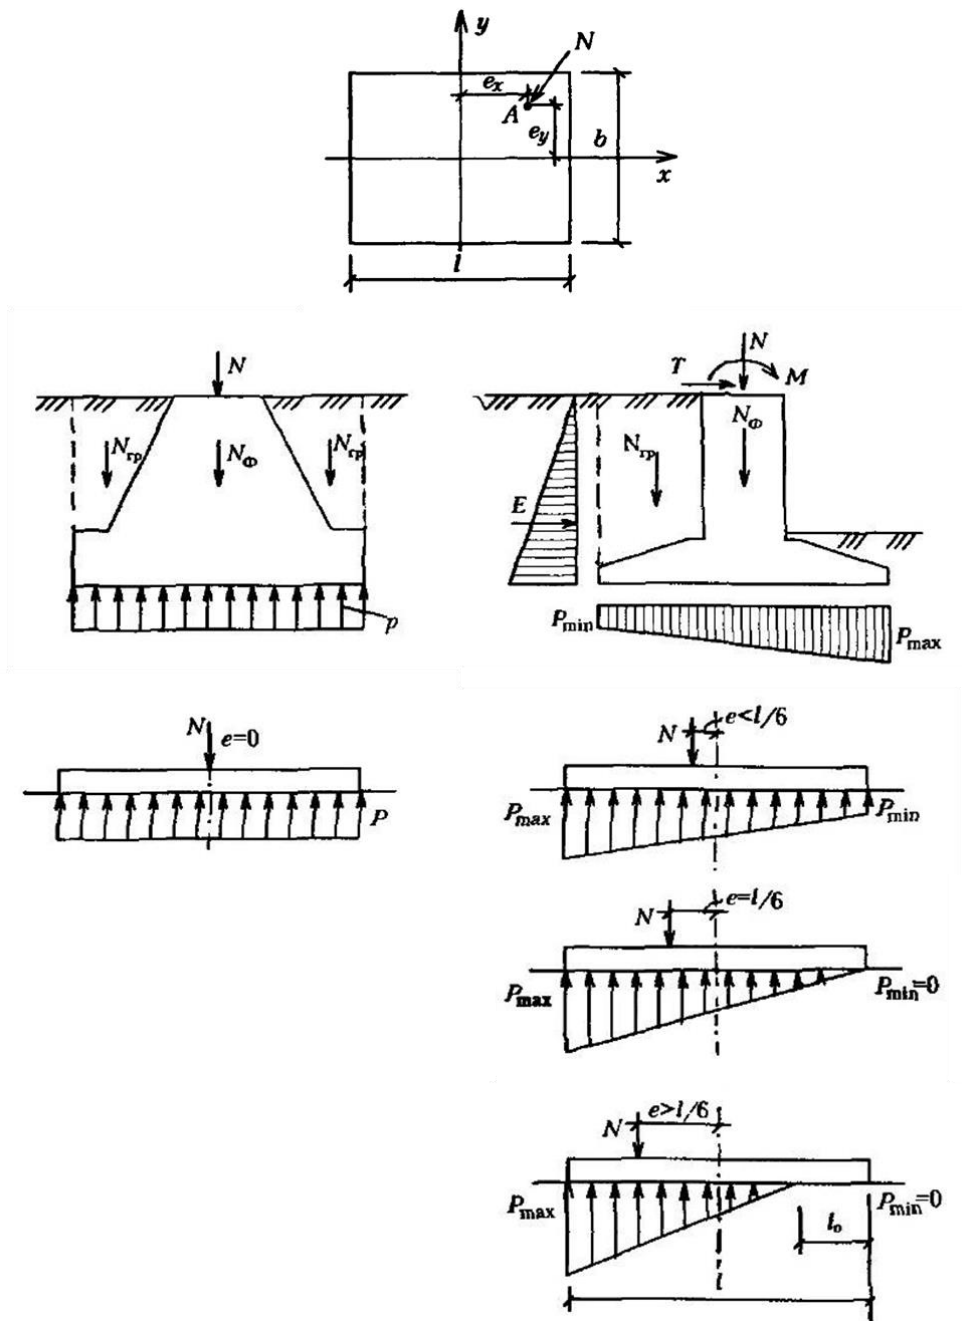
Схема підосви і епюри тиску по краях підосви: а – центрально-навантаженого фундаменту; б – позацентрово-навантаженого фундаменту
